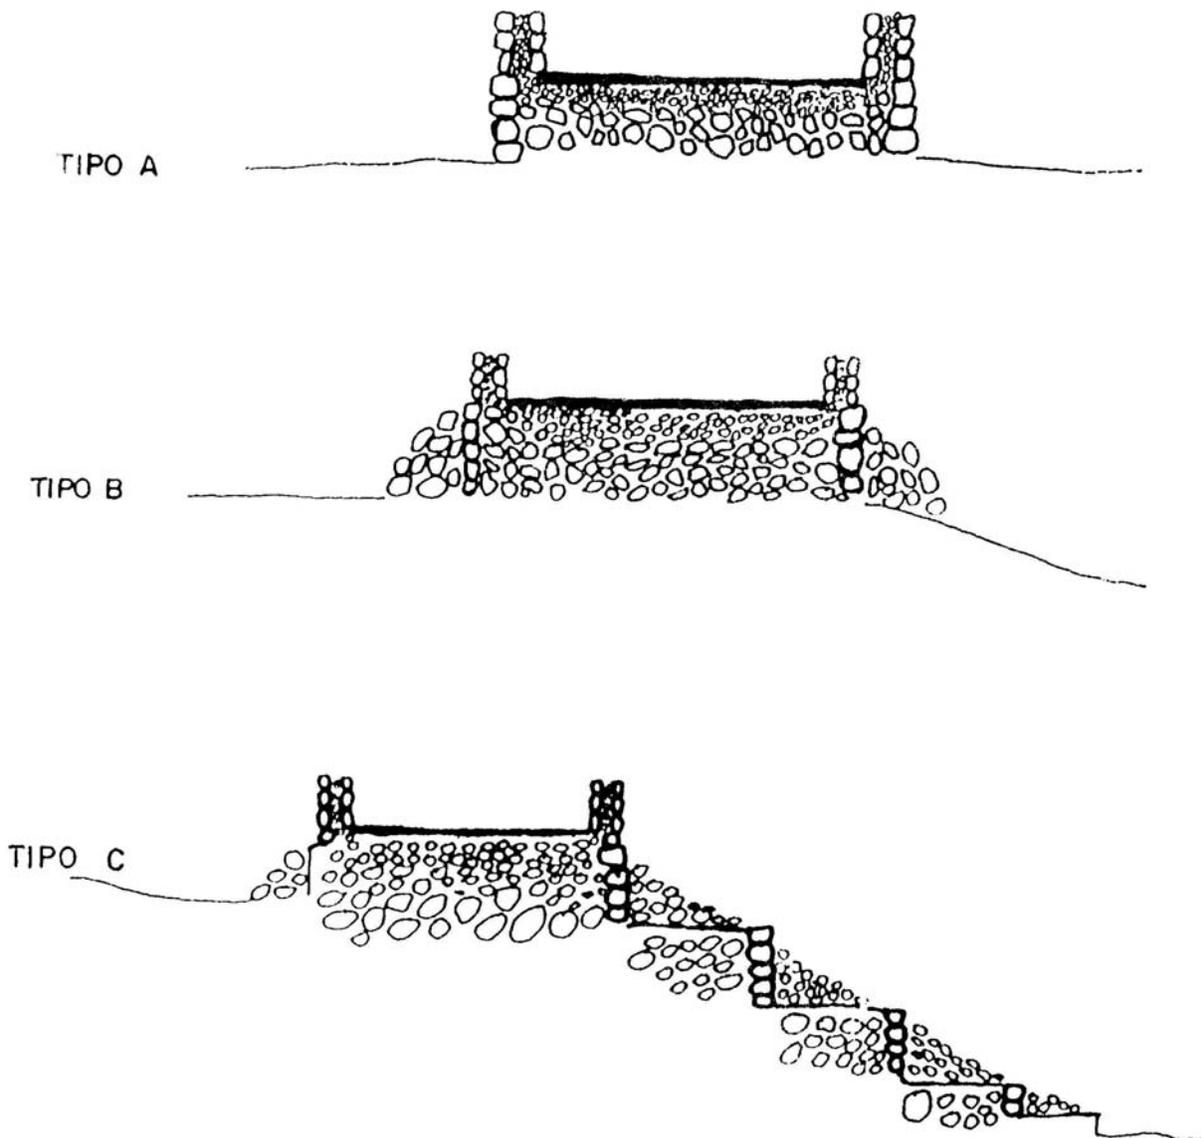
Tipos constructivos de calzadas: A) Tipo A; B) Tipo B; C) Tipo C
